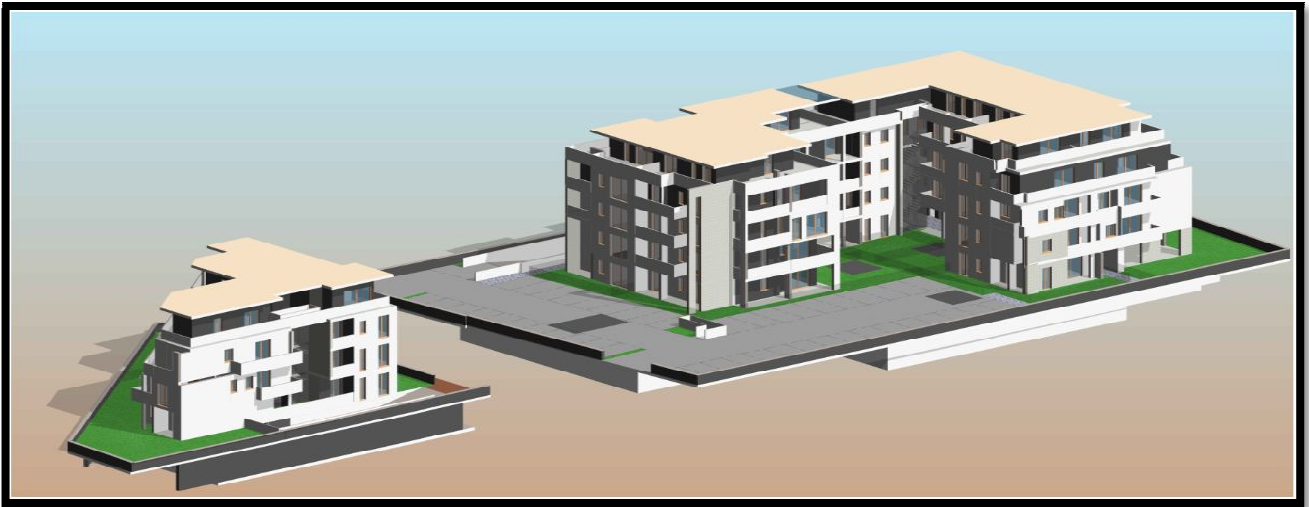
RENDERIZZAZIONE DEL PROGETTO BRIVIO
